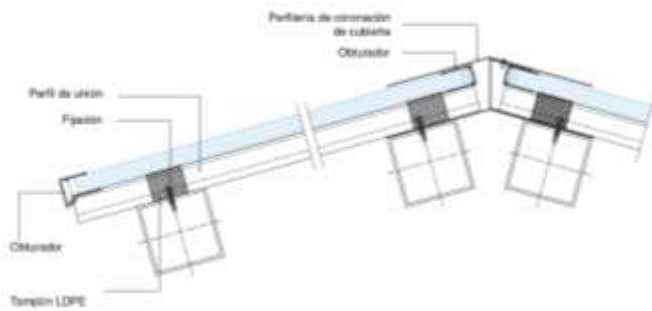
Instalación del sistema como cerramiento de cubierta. Paneles planos.
